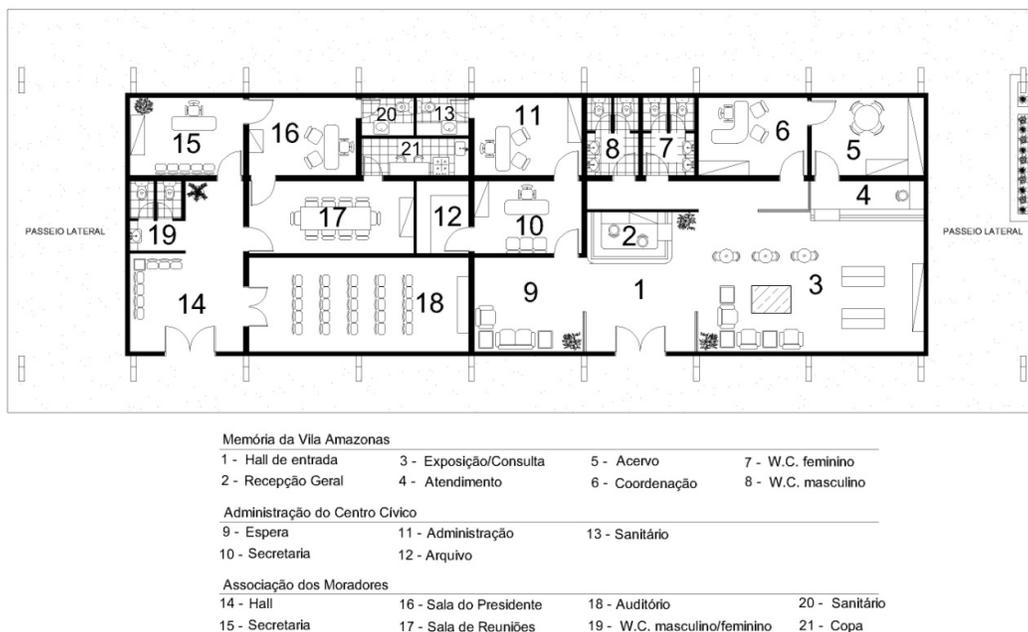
Planta de Layout do projeto de intervenção no Bloco de Administração de Vilas.
